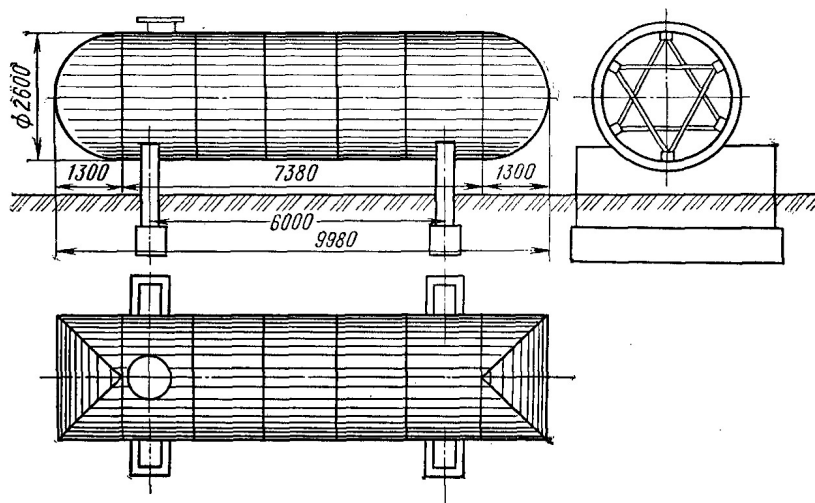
Горизонтальный резервуар с цилиндрическими днищами
